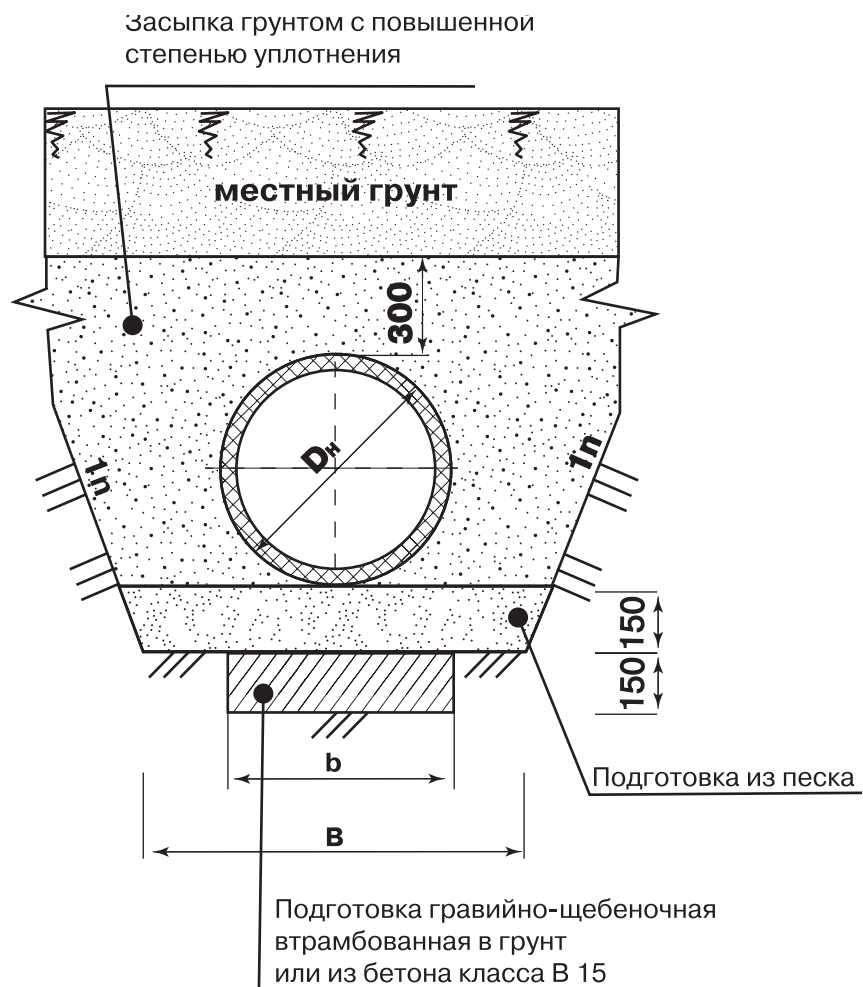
Схема укладки труб, грунт основания: водонасыщенные грунты со слабой водоотдачей
